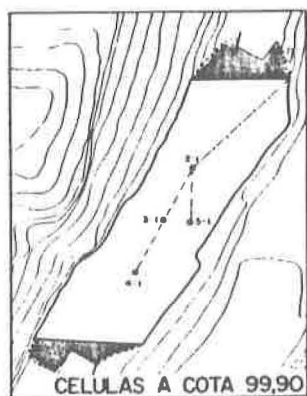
PLANTA, PERFIL Y DISTRIBUCION DE CELULAS
